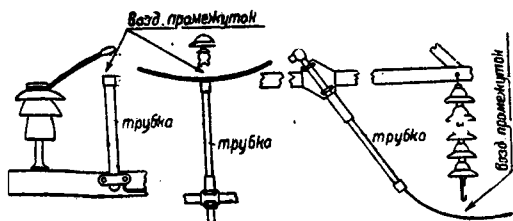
Эскизный вид крепления трубки для защиты штыревого изолятора и гирлянды
